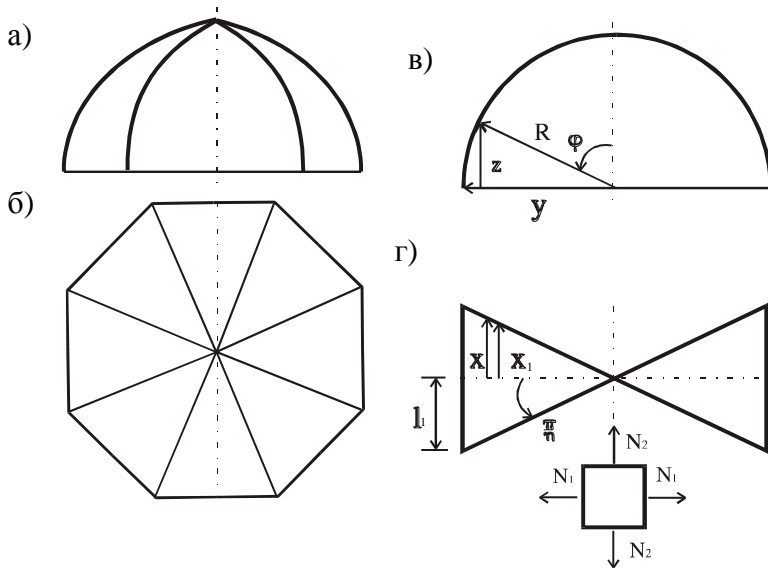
Сомкнутый свод: а) – фасад; б) – план; в) – разрез; г) схема усилий
